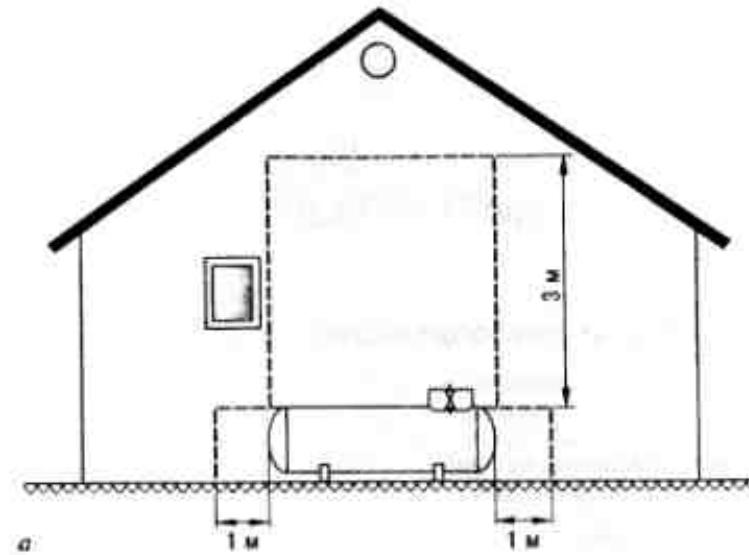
Принципиальная схема проекционной площи; требования к наружной стене здания:
